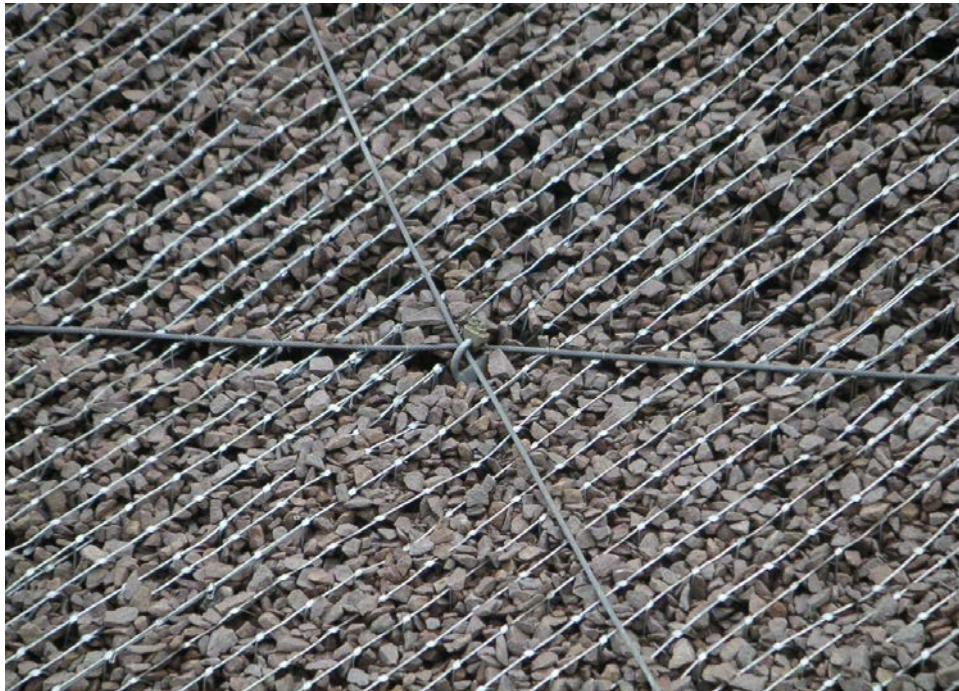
Panel de malla metálica con relleno de grava – detalle de un elemento de conexión
